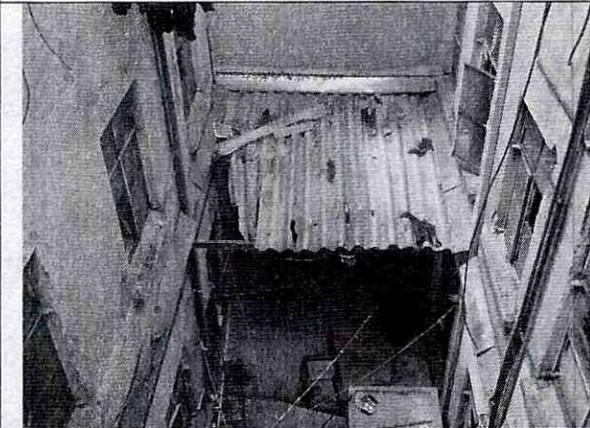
Aspecto general cubierta patio primer piso. Rotura de tejas
